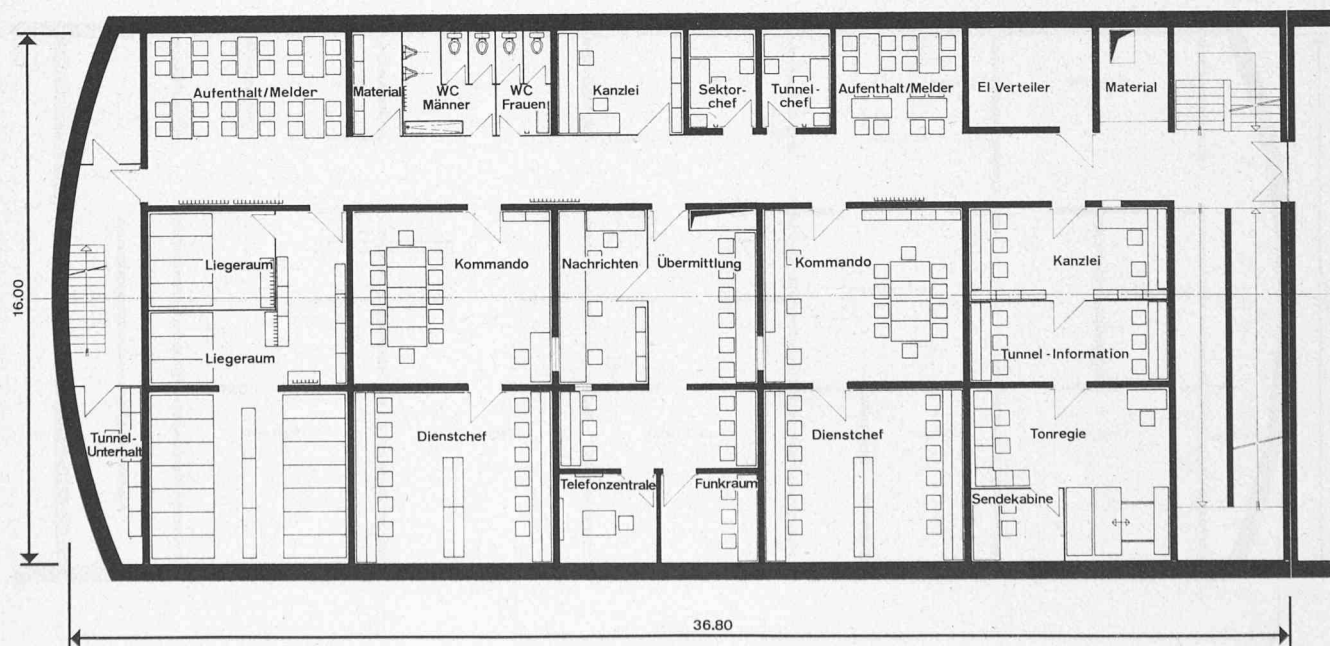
Grundriss des dritten Obergeschosses (3. OG) der ZSO-Kaverne. Sektor-Kommandoposten und Tunnelleitung
